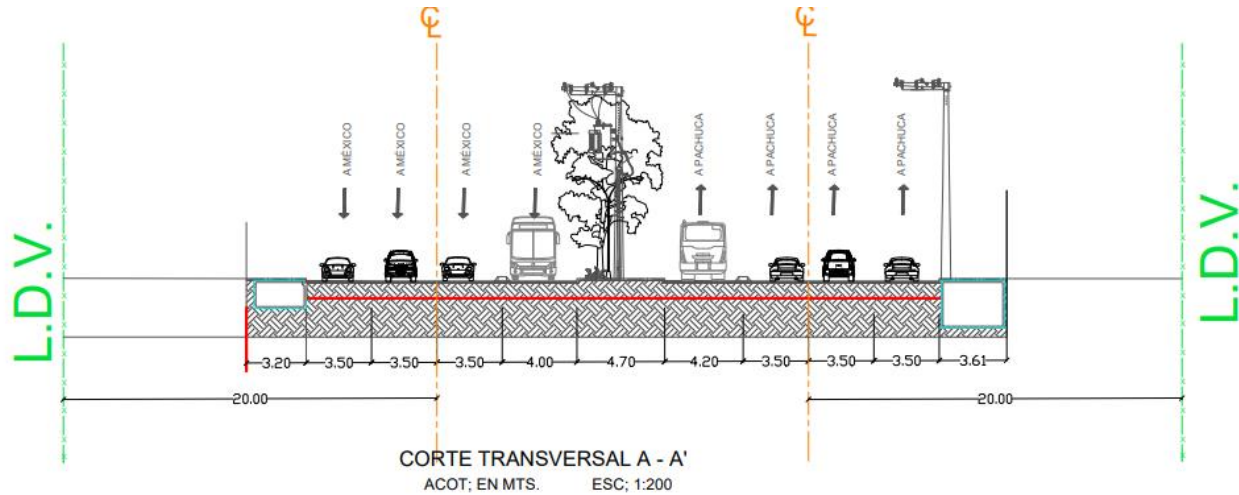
Corte transversal, el eje vial. Autoría propia. CDMX; agosto 2023
